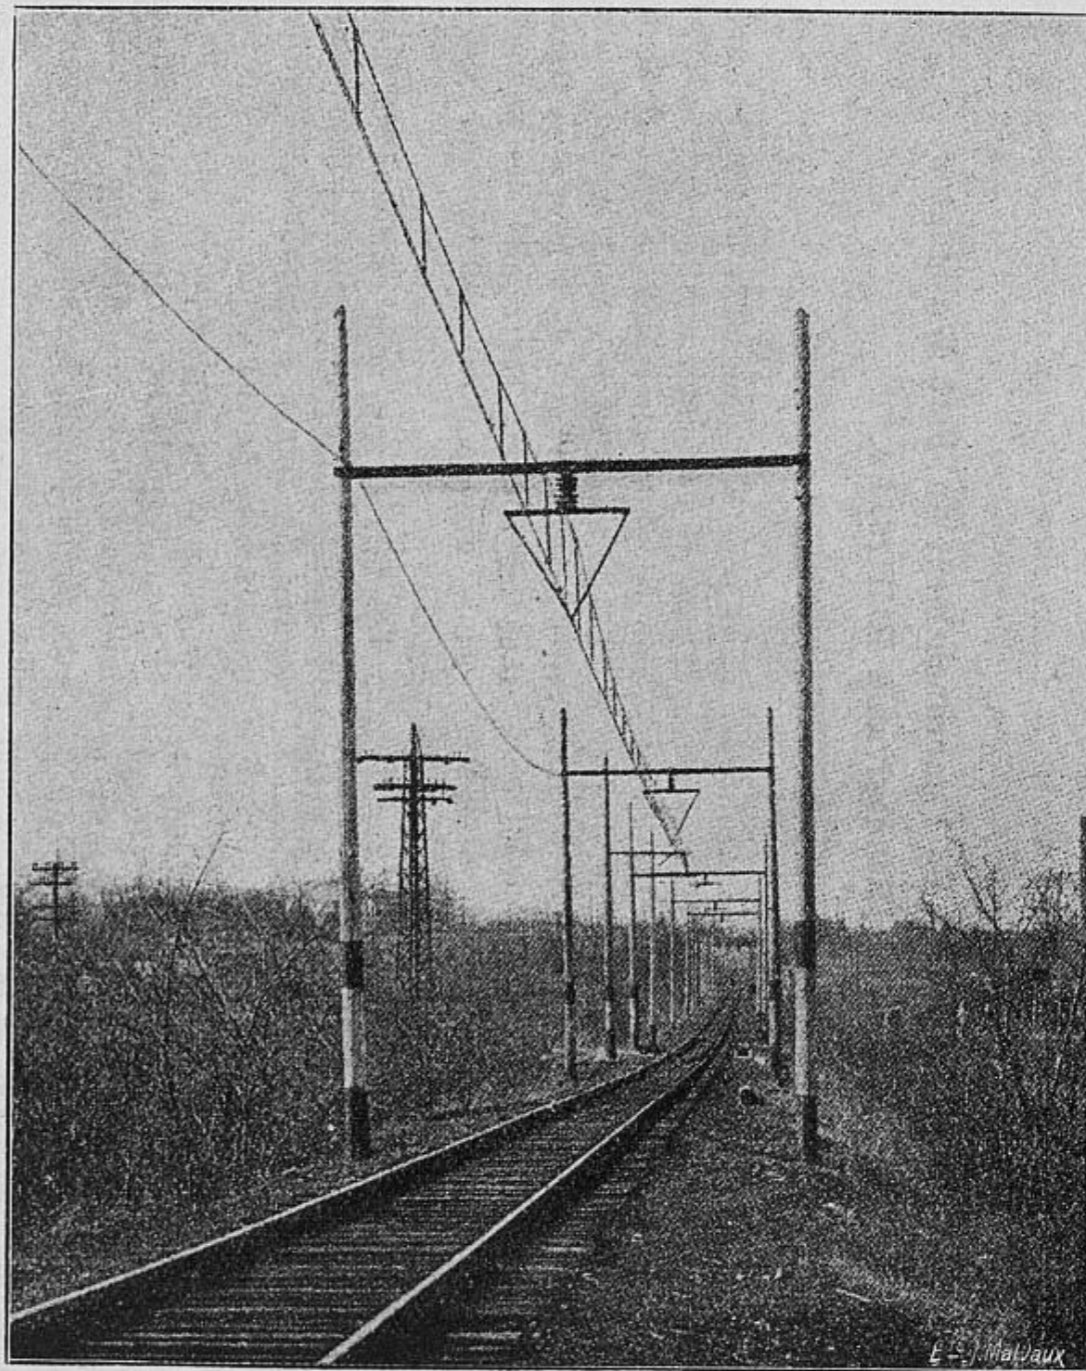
Construction aérienne sur une section en remblai de l'embranchement du Fort Washington, où le haubanage des supports était impossible.
